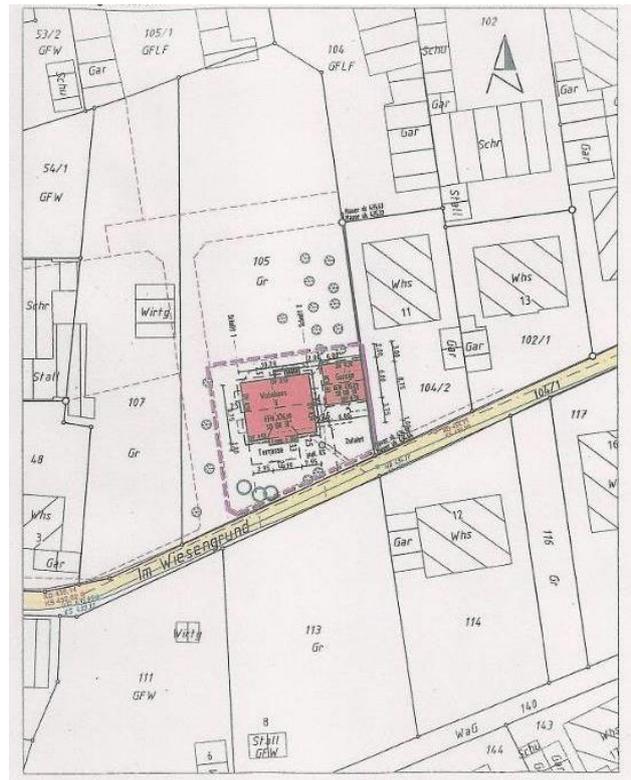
Lageplan Baugesuch Flst.Nr. 105
